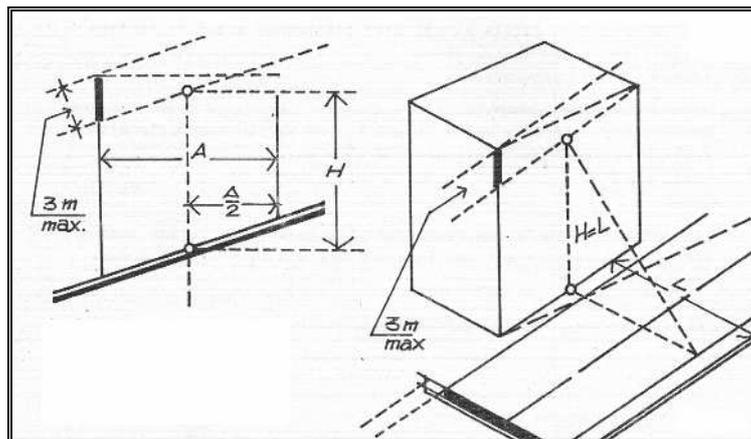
Construction sur une voie en pente : détermination de la hauteur.
